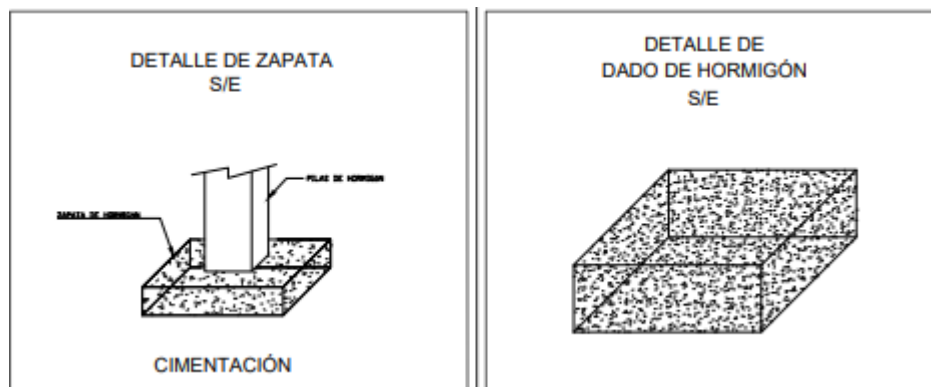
Detalle de zapata y dado de hormigón para puente elevado.
